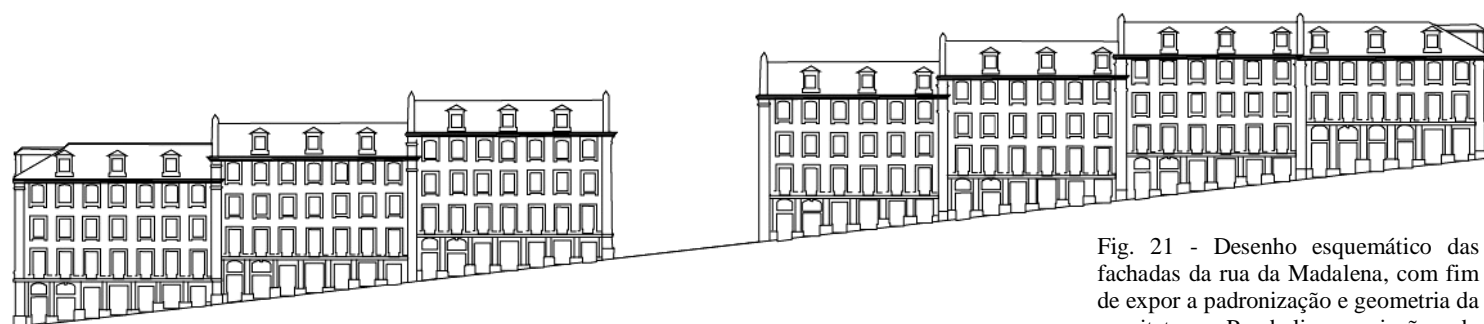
Desenho esquemático das fachadas da rua da Madalena, com fim de expor a padronização e geometria da arquitetura Pombalina, criação do autor.
